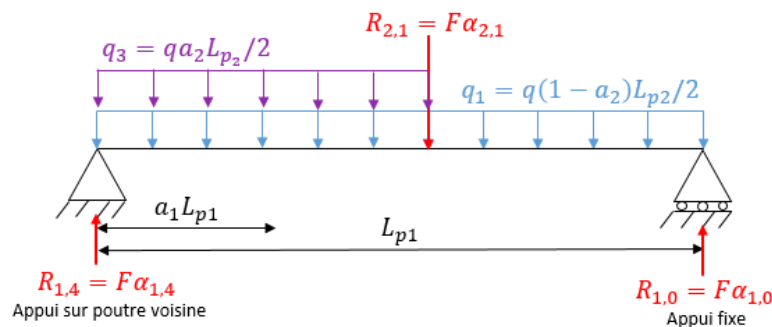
Schéma statique d'une poutre type 1 du plancher rectangulaire avec 2 sens de portée
